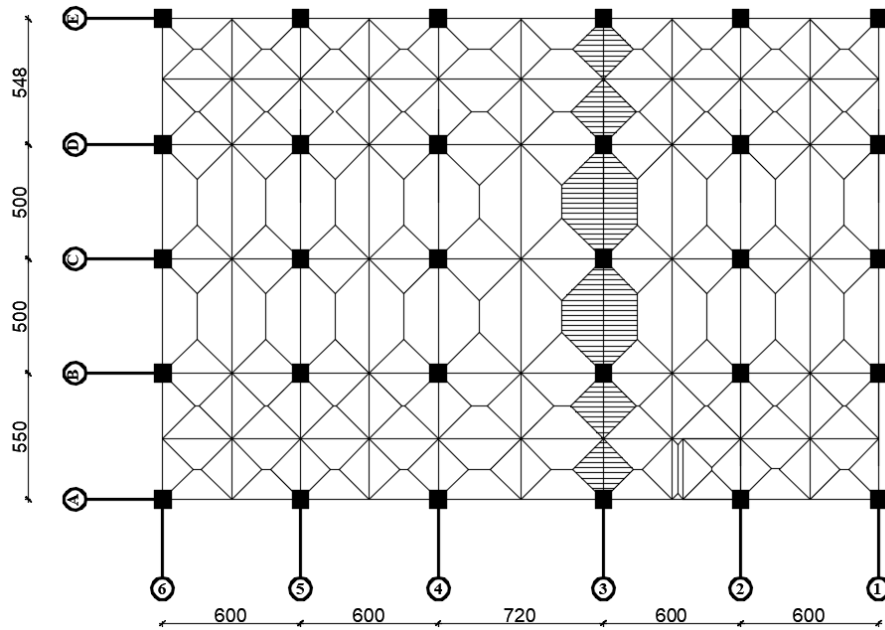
8 Denah Potongan Portal As B Lantai 7 dan Dak Atap
